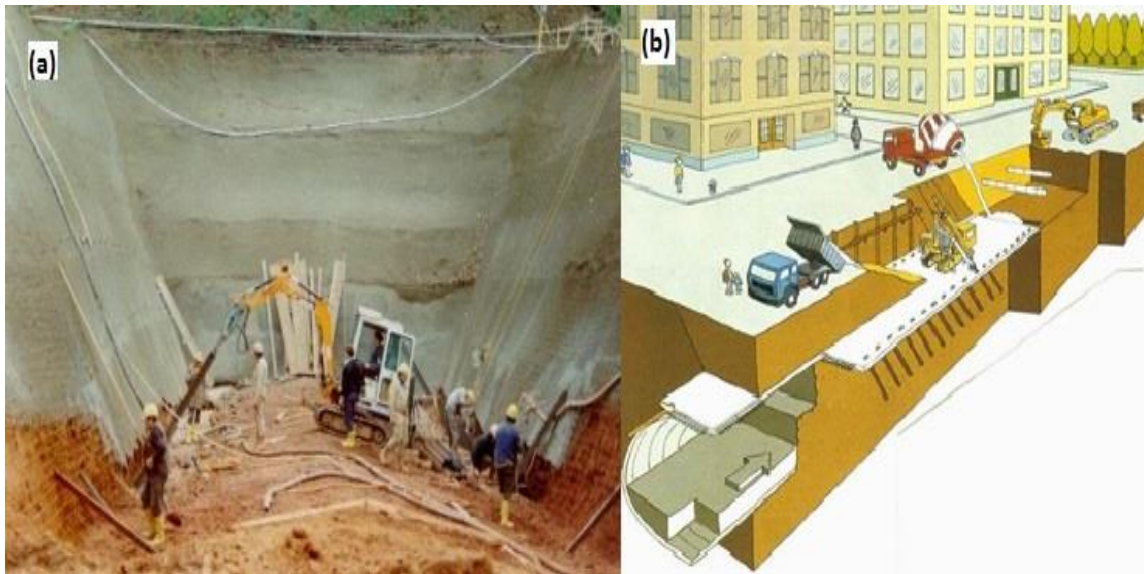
Método construtivo denominado túnel invertido. (a) vista da execução da escavação em Oberrieden; (b) esquema construtivo (Sauer, 2004).
